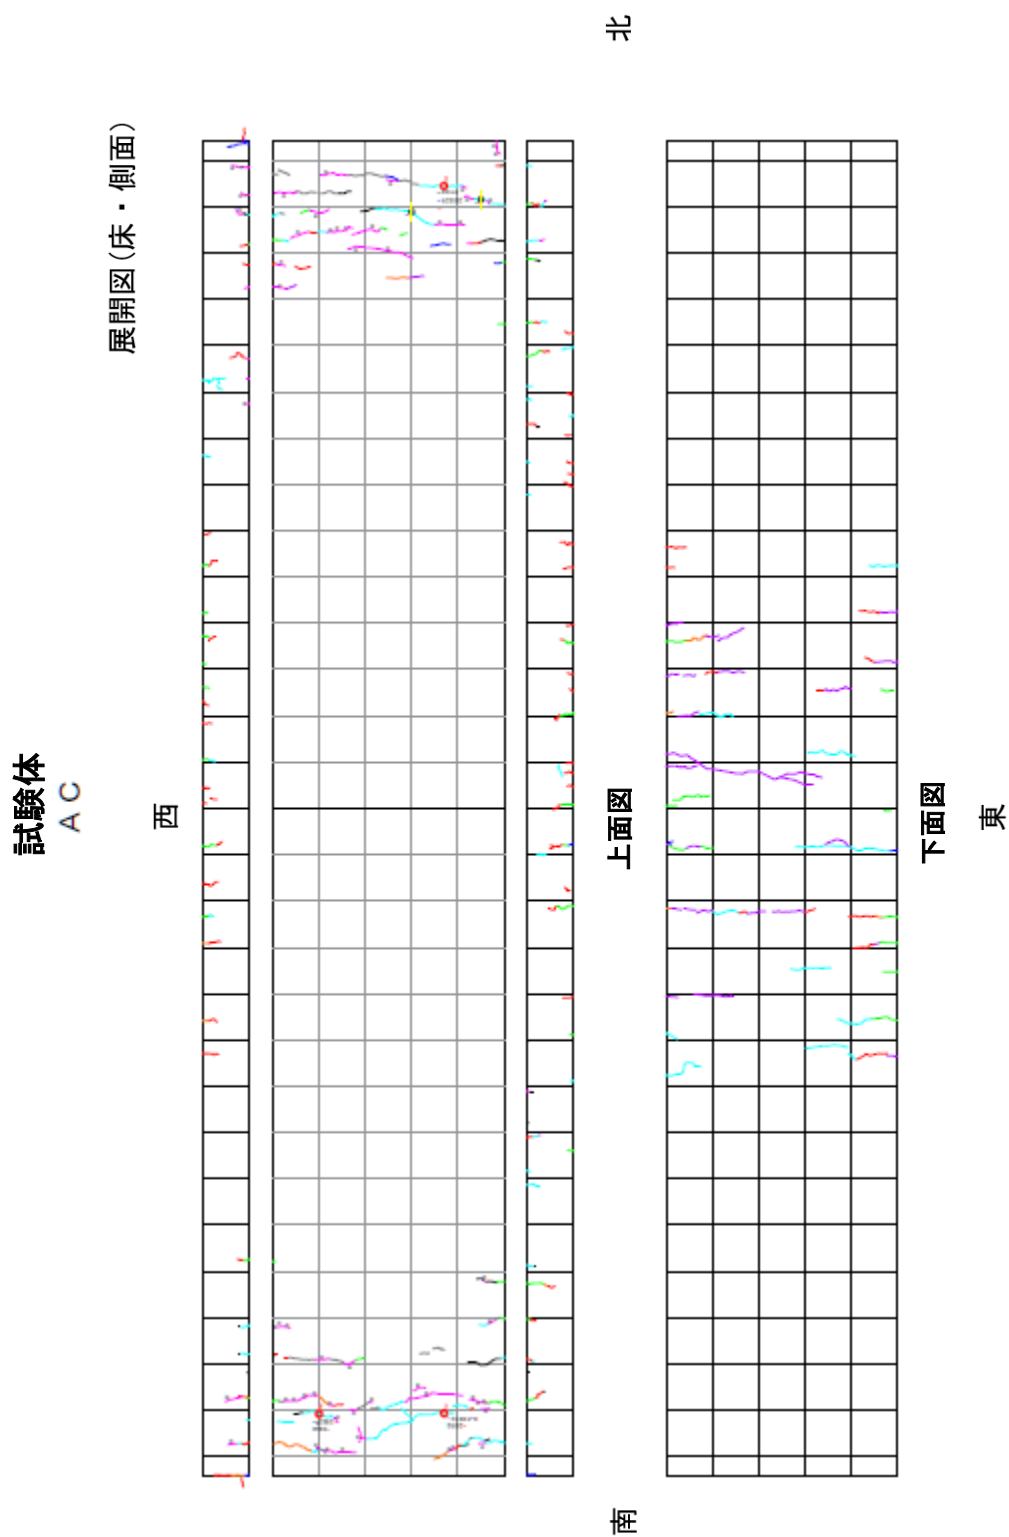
試験体 AC ひび割れ図
